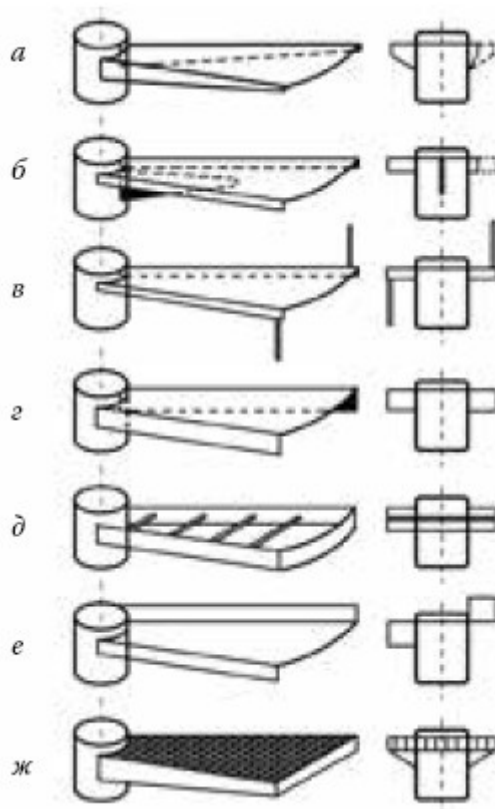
Устройство стальных ступеней винтовой лестницы и их вид в разрезе:
